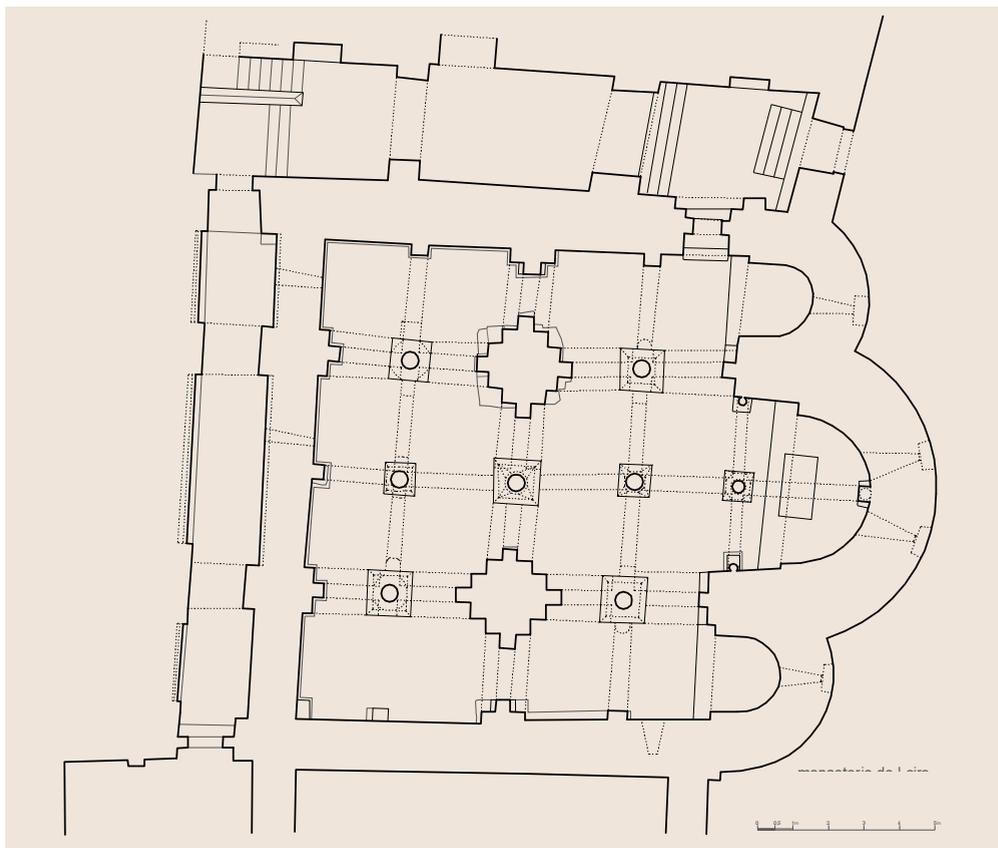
Cripta de San Salvador de Leire. Planta (Archivo Fundación Santa María la Real)
